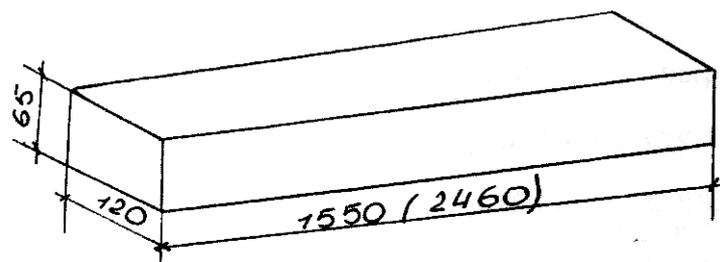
Брусковая перемычка 2ПБ16-2 Балочные перемычки проектируют в несущих стенах, воспринимающих нагрузку от перекрытия.
